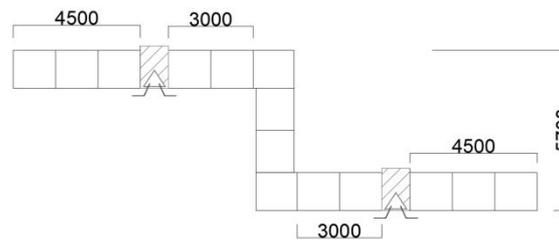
典型的 Z 型双柱导架爬升式工作平台示意图(单位: mm)
